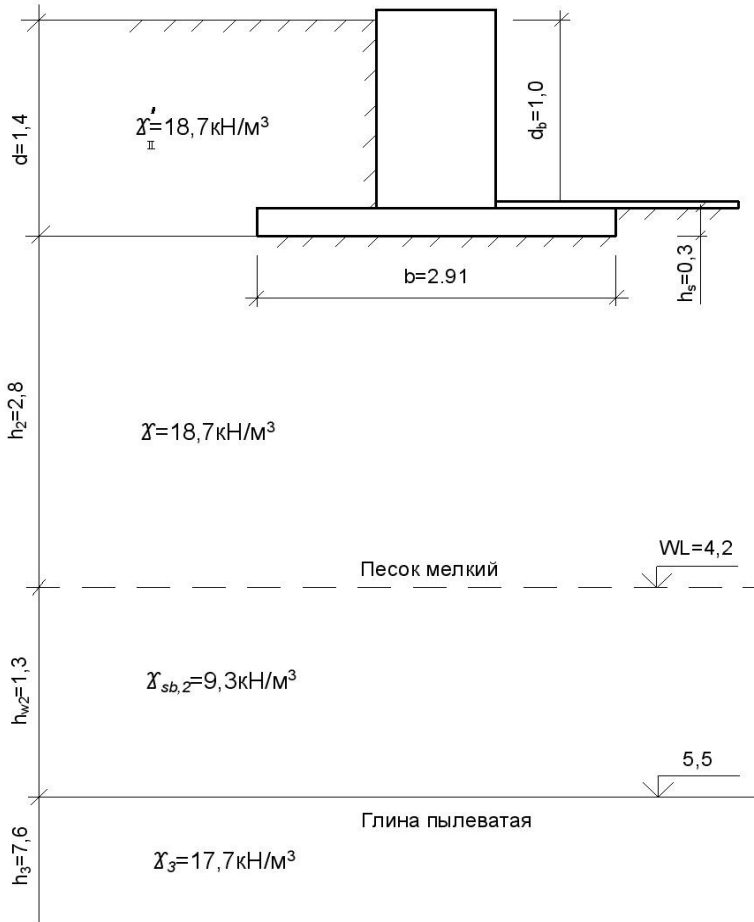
Схема расположения фундамента мелкого заложения в грунтовом массиве
